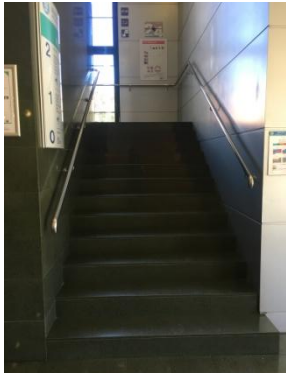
Escaleras de acceso de la planta 0 a la 1.
